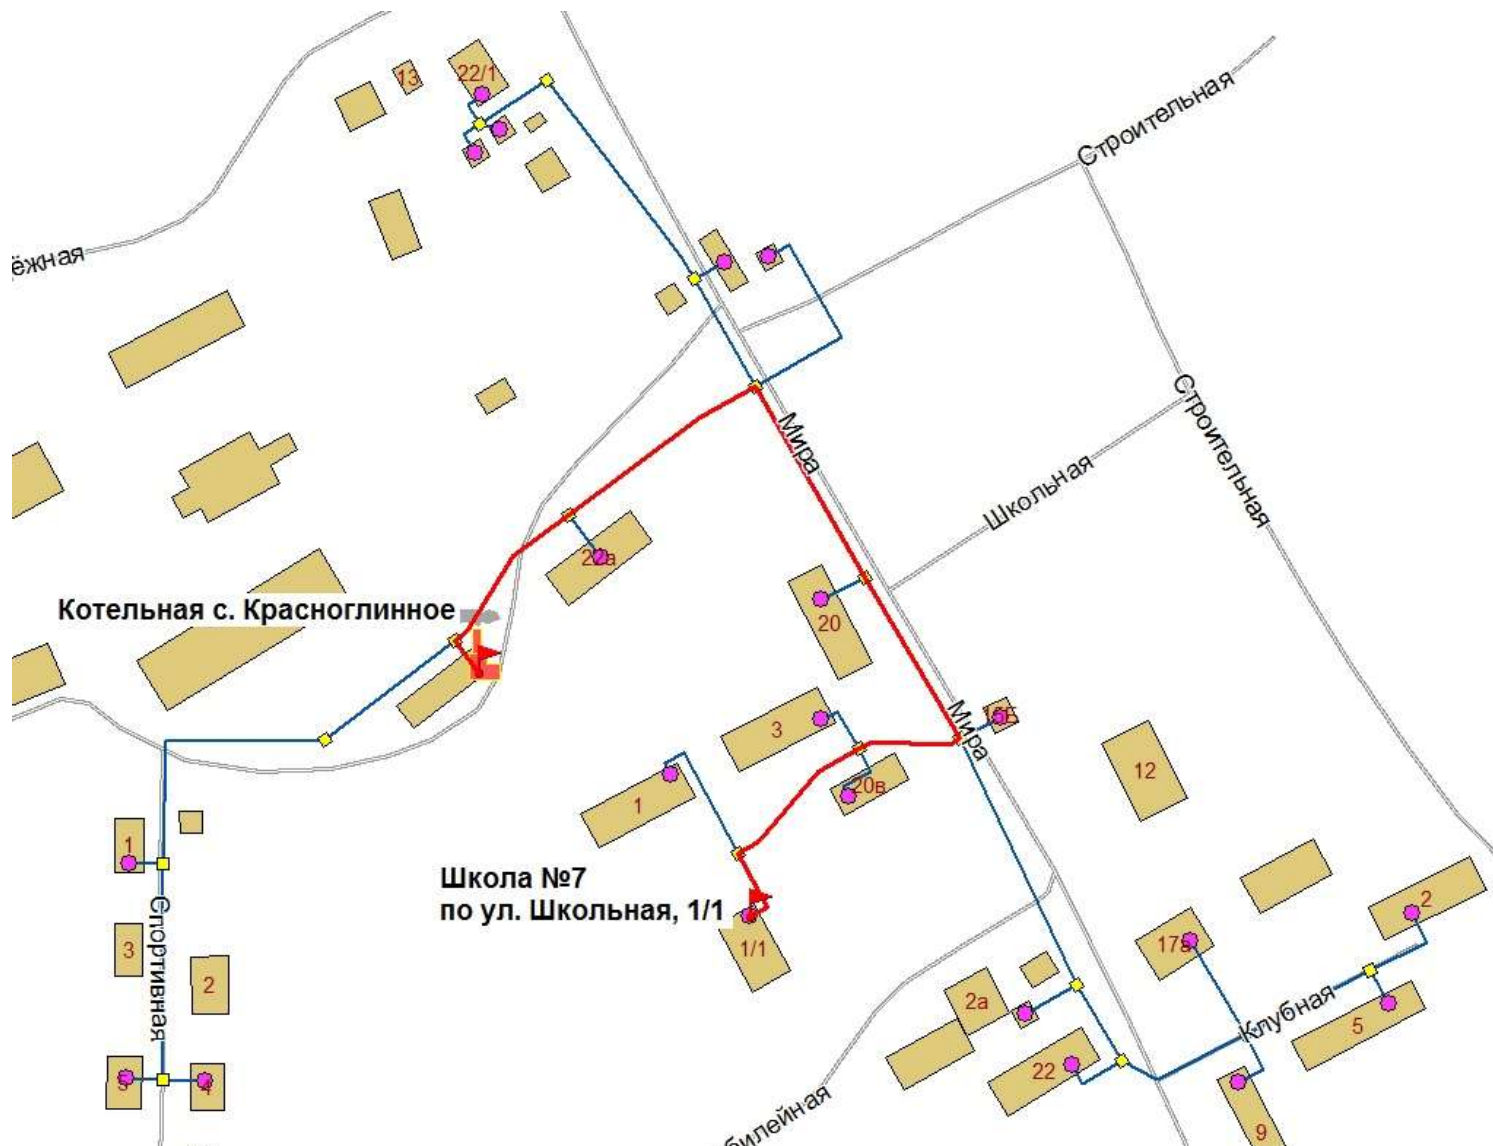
Трассировка теплопровода «Котельная с. Красноглинное – Школа №7 по ул. Школьная, 1/1»
